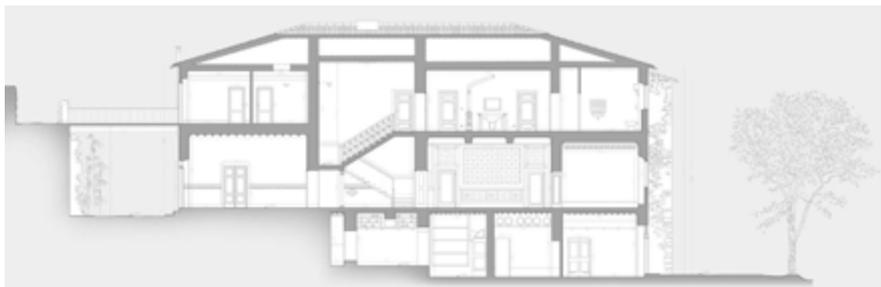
Sezione longitudinale, in evidenza il passaggio sospeso d'accesso al piano primo ed i collegamenti verticali
